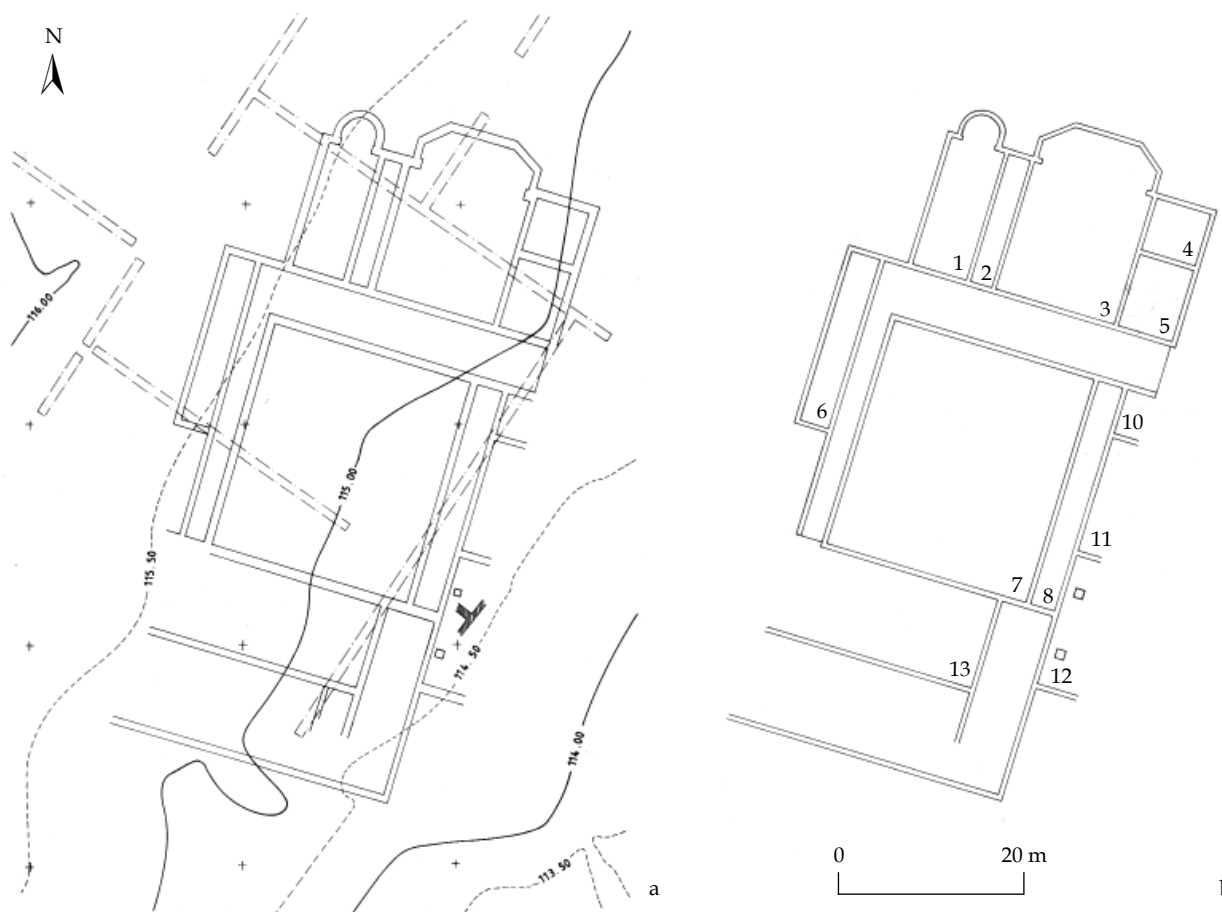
Das Hauptgebäude (Nr. VII) der Festung von Ságvár: a mit den Grabungsschnitten und dem anhand deren rekonstruierten Grundriss; b Rekonstruierter Grundriss mit Nummern der einzelnen Räumlichkeiten (s. dazu Text). – Nach TÓTH/HORVÁTH 2019, Abb. 5.
